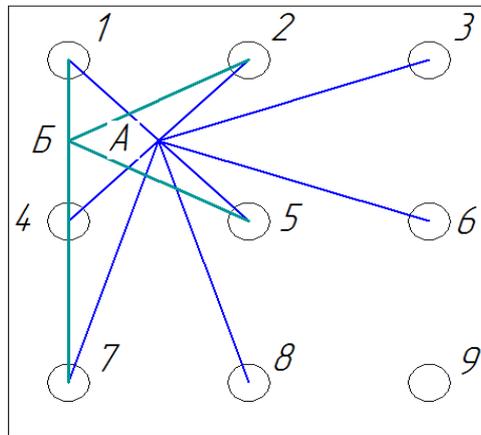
План помещения с указанием расстояний от условных точек до светильников
